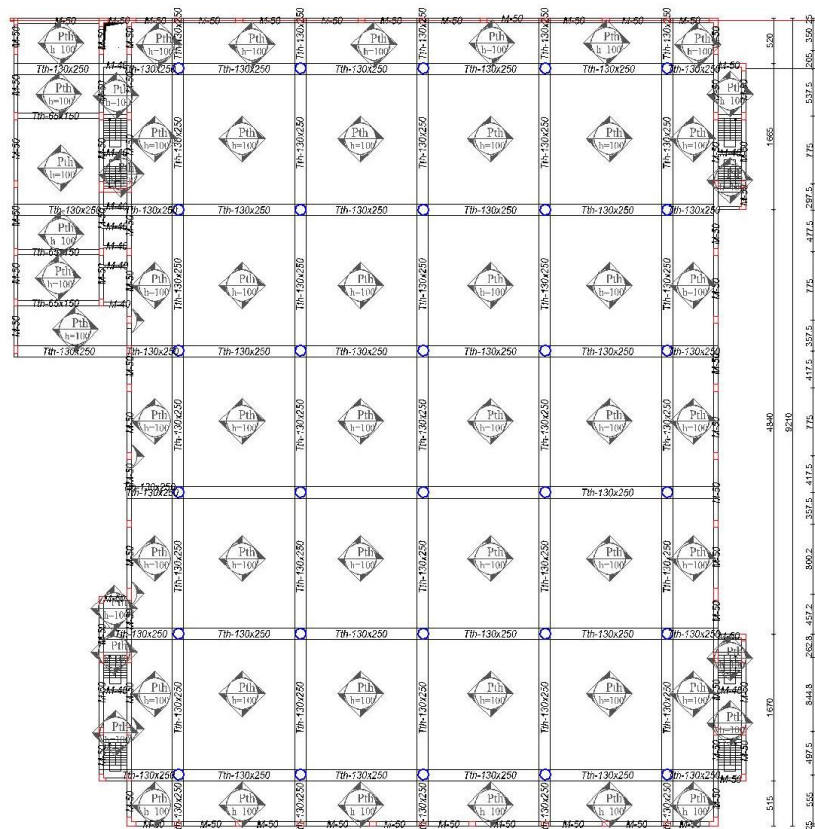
Plani i kolonave dhe strukturave ne kuoten -19.00 m
